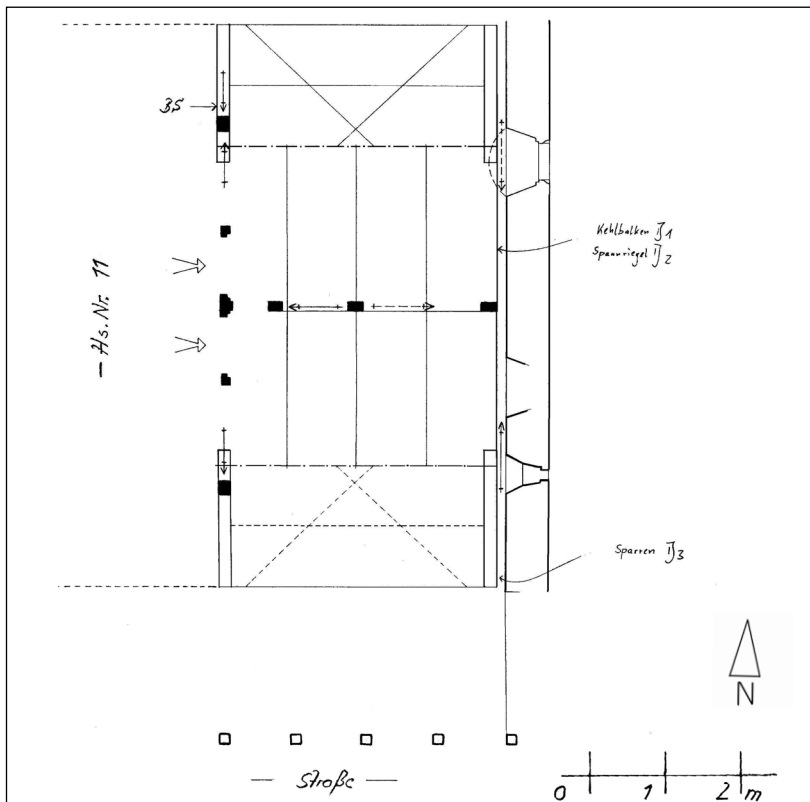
Spitalstraße 13, Grundriss 1. Dachgeschoss.
